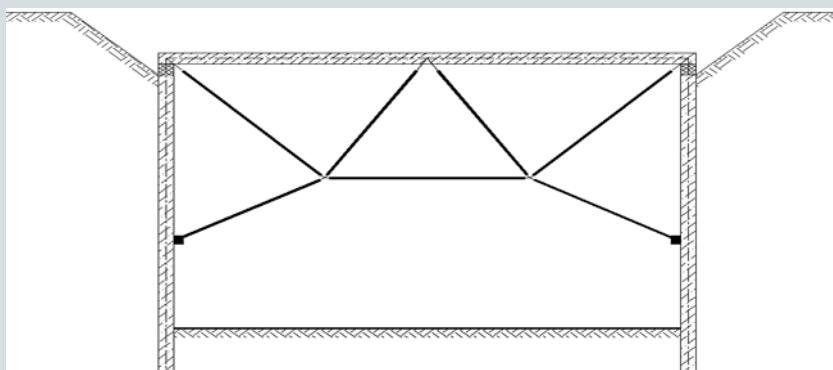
Распорная конструкция крепления котлована с одним капитальным перекрытием, которое усилено инвентарной стальной конструкцией
